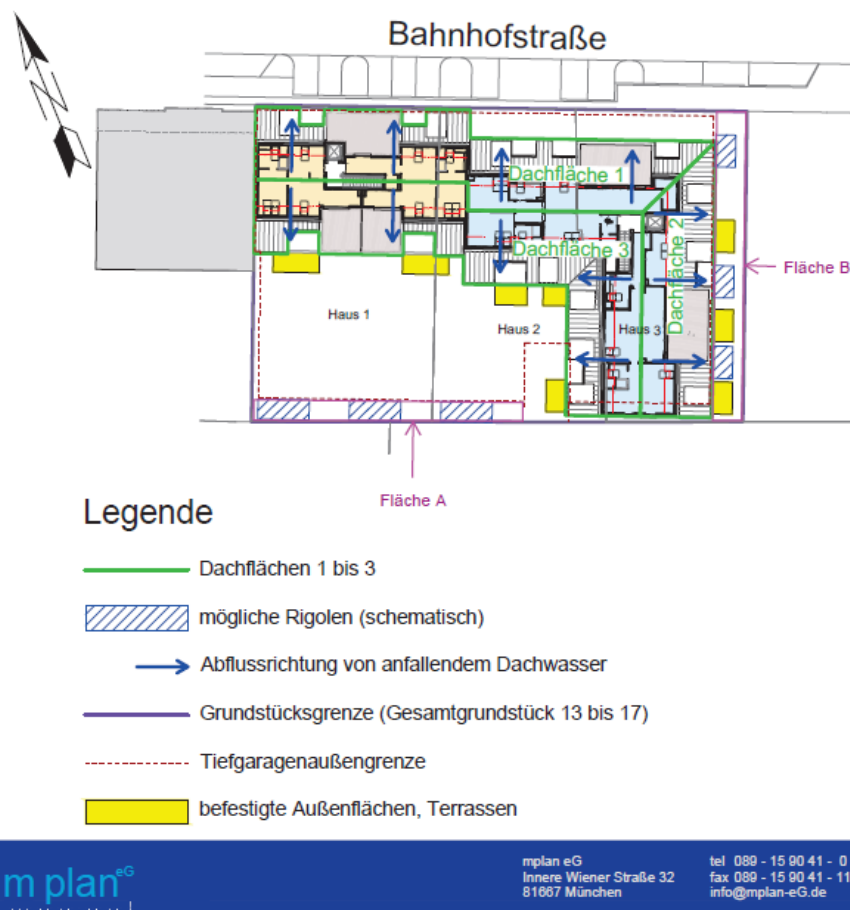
Lageplan mit Darstellung des Entwässerungskonzeptes, Büro m plan, Stand 29.11.2024
